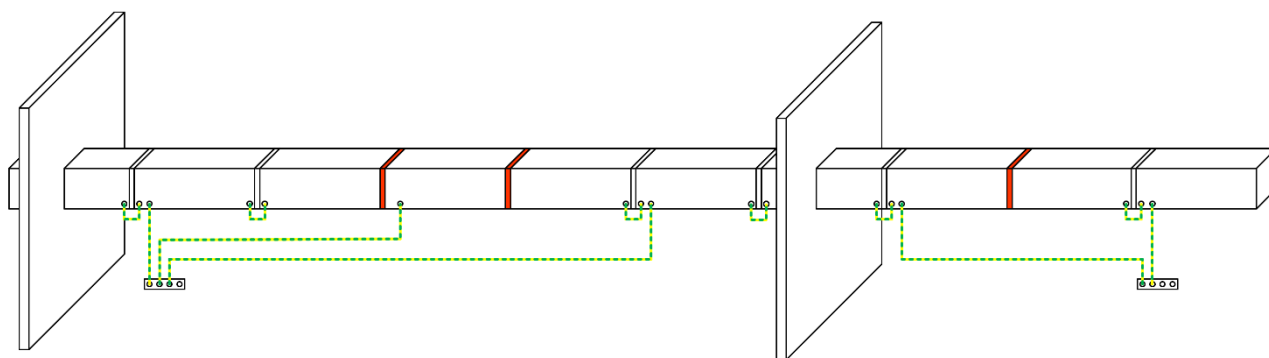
Conduit de ventilation avec liaison équipotentielle
